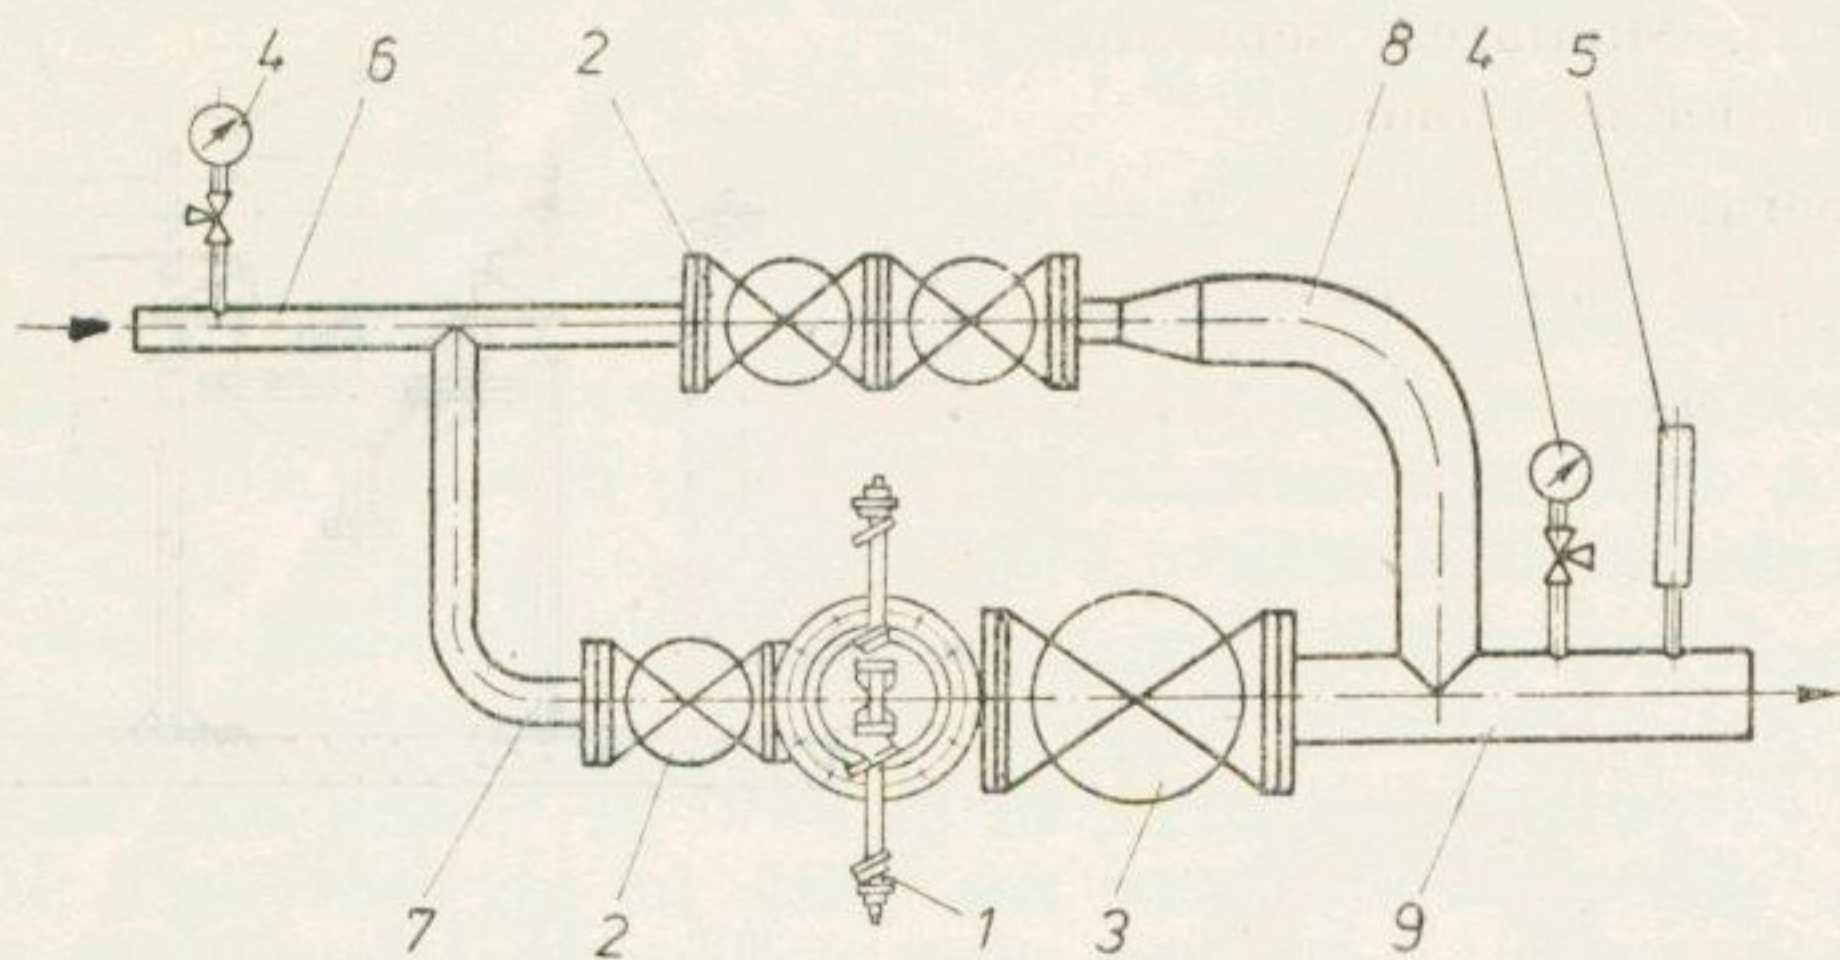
Ansamblu de montaj reductor de presiune pentru abur :
